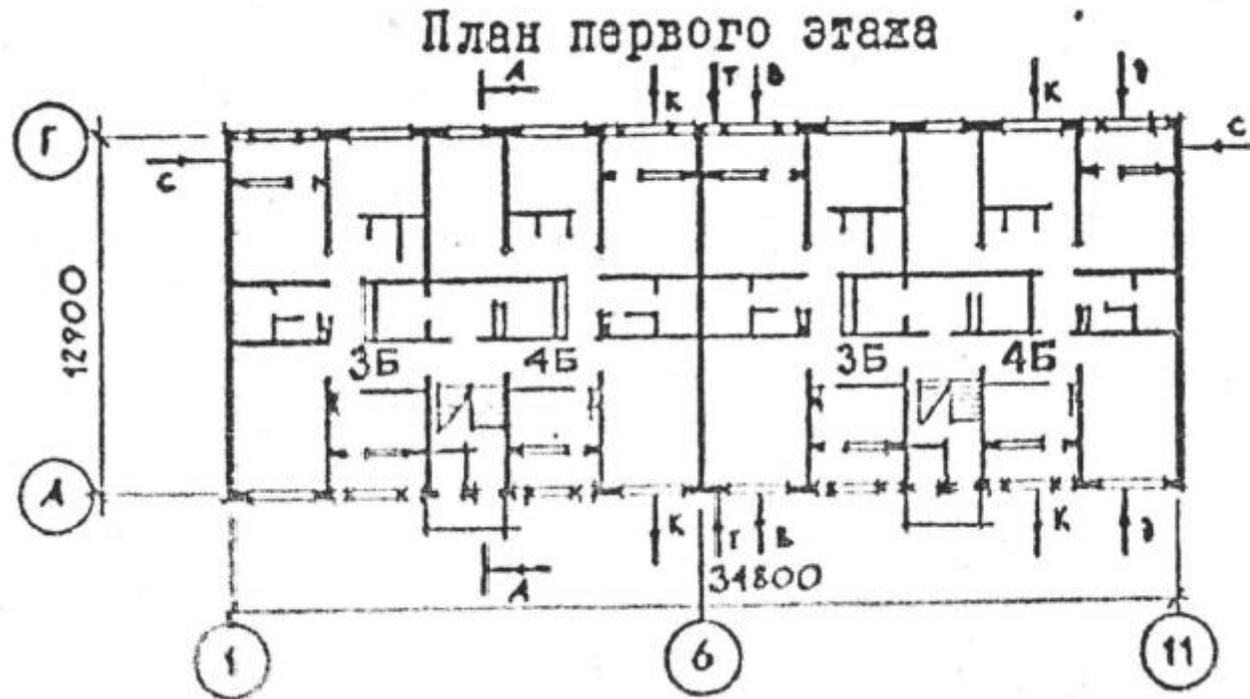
Grundriss Gebäudetyp 158 (ohne Maßstab)
